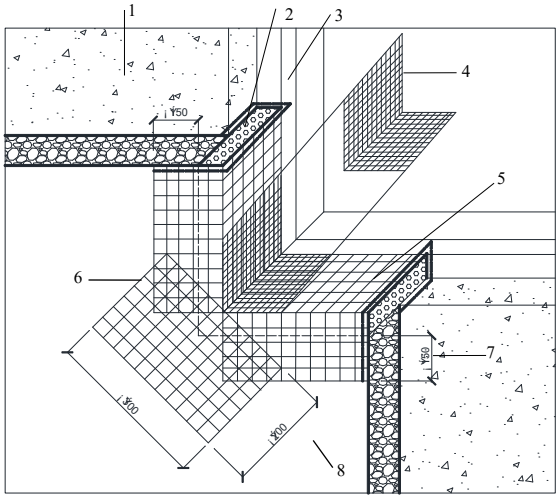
门窗洞口处耐碱玻纤网设置示意图
